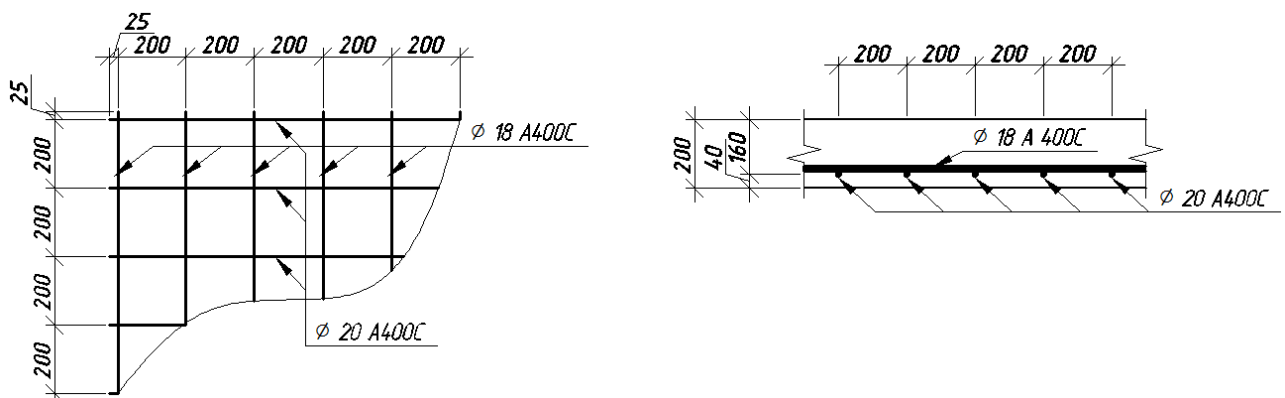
Армування монолітної плити підвального поверху.
